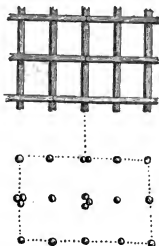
Plan des poutrelles et plan des pilotis de la marâtre de Castione.
